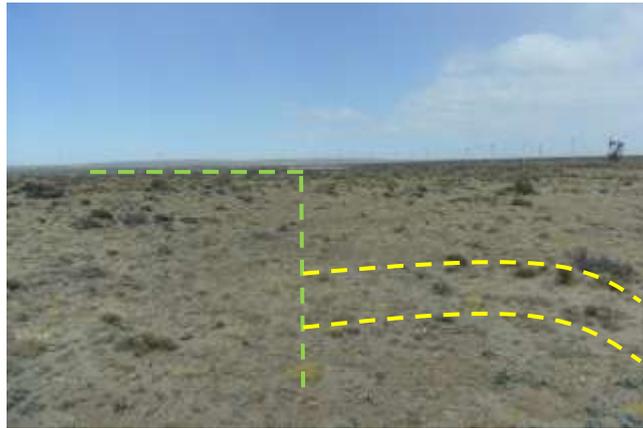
Camino de acceso a la locación de la Batería LC V, vértice NO. Empalme con camino de acceso del Pozo LC-827. Foto en dirección S.
